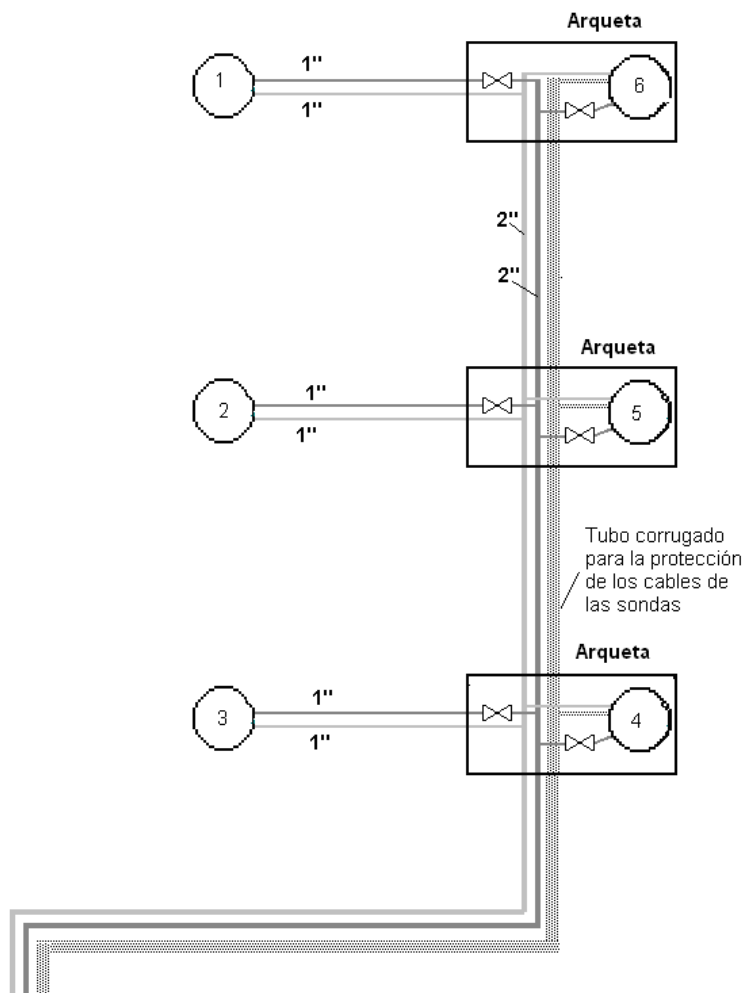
Esquema en planta del intercambiador vertical, colectores horizontales y arquetas
